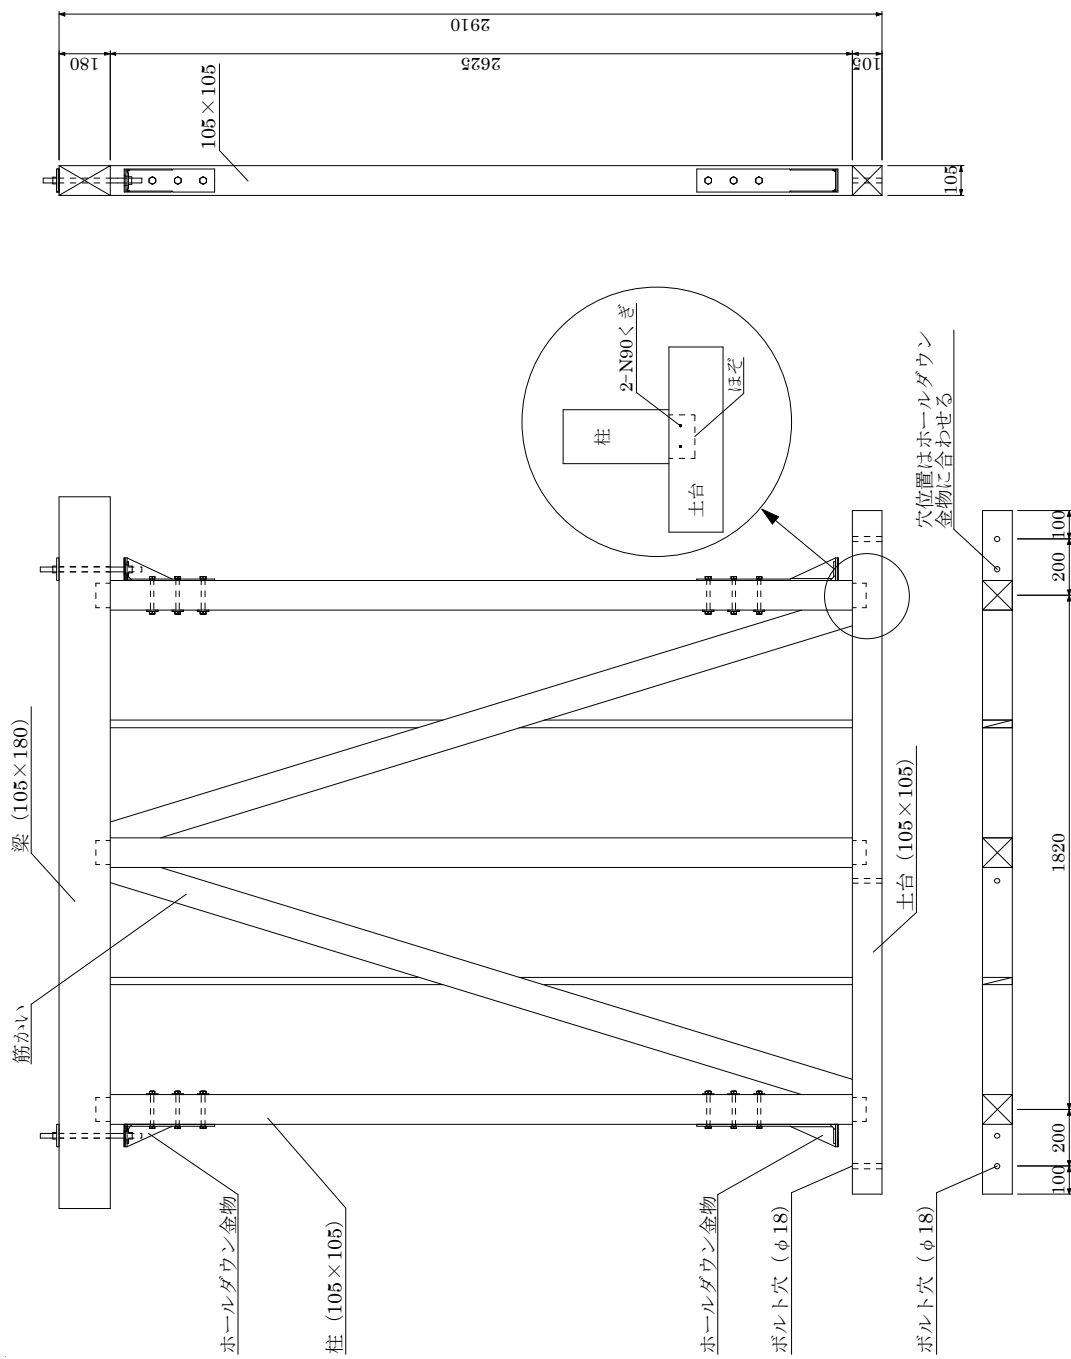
軸組耐力壁の試験体例 (筋かい系, 2Pタイプ) (寸法単位: mm) (い) (に)
